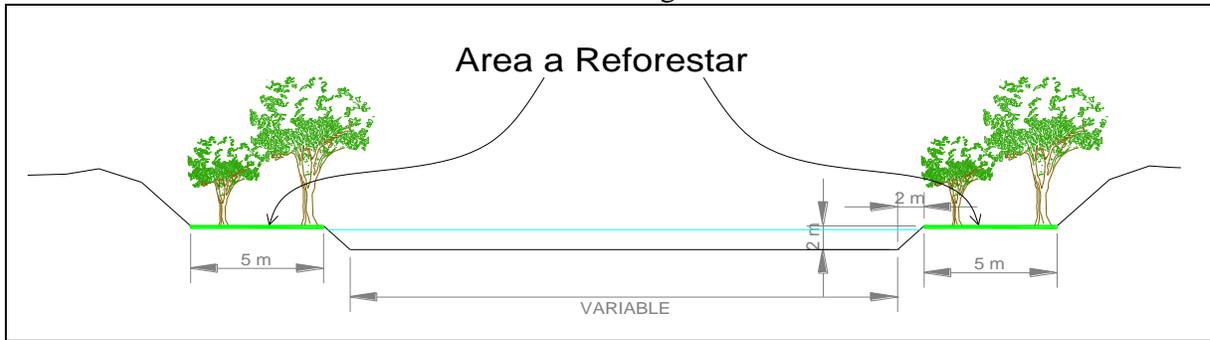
Sección tipo del cauce con el proyecto finalizado.
